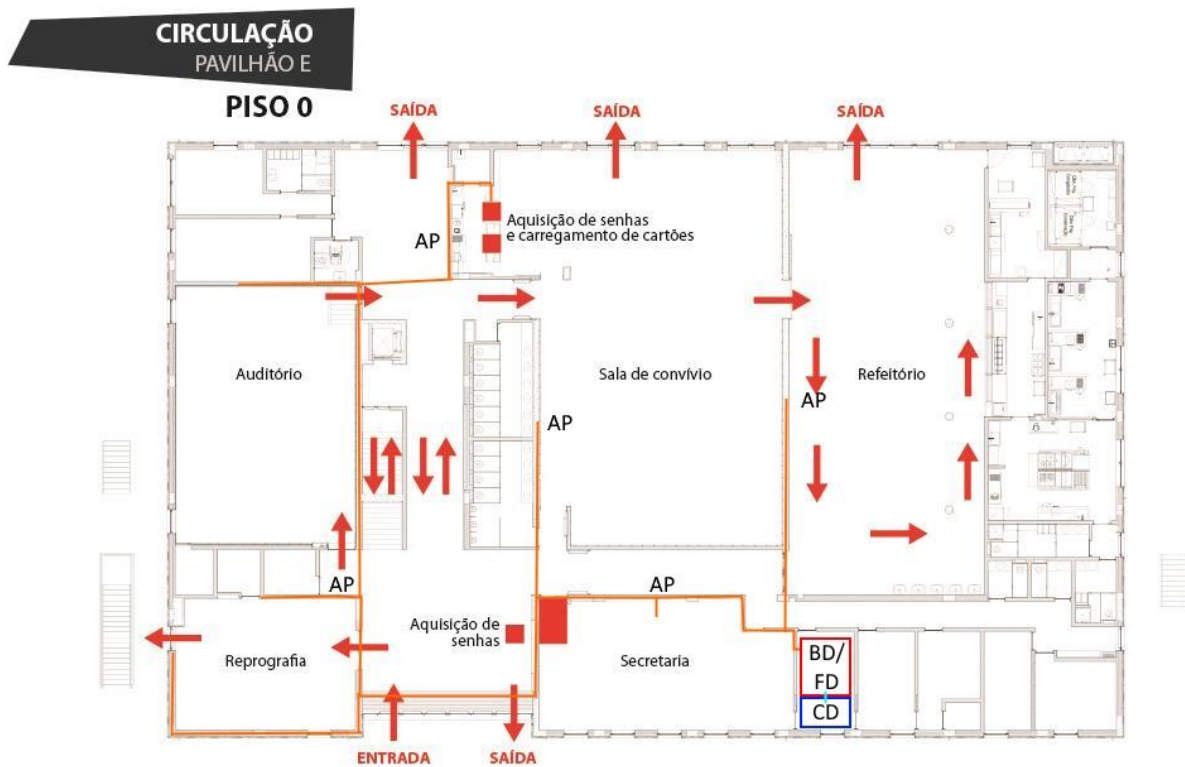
Esquema de Cablagem do Pavilhão E Piso 0
